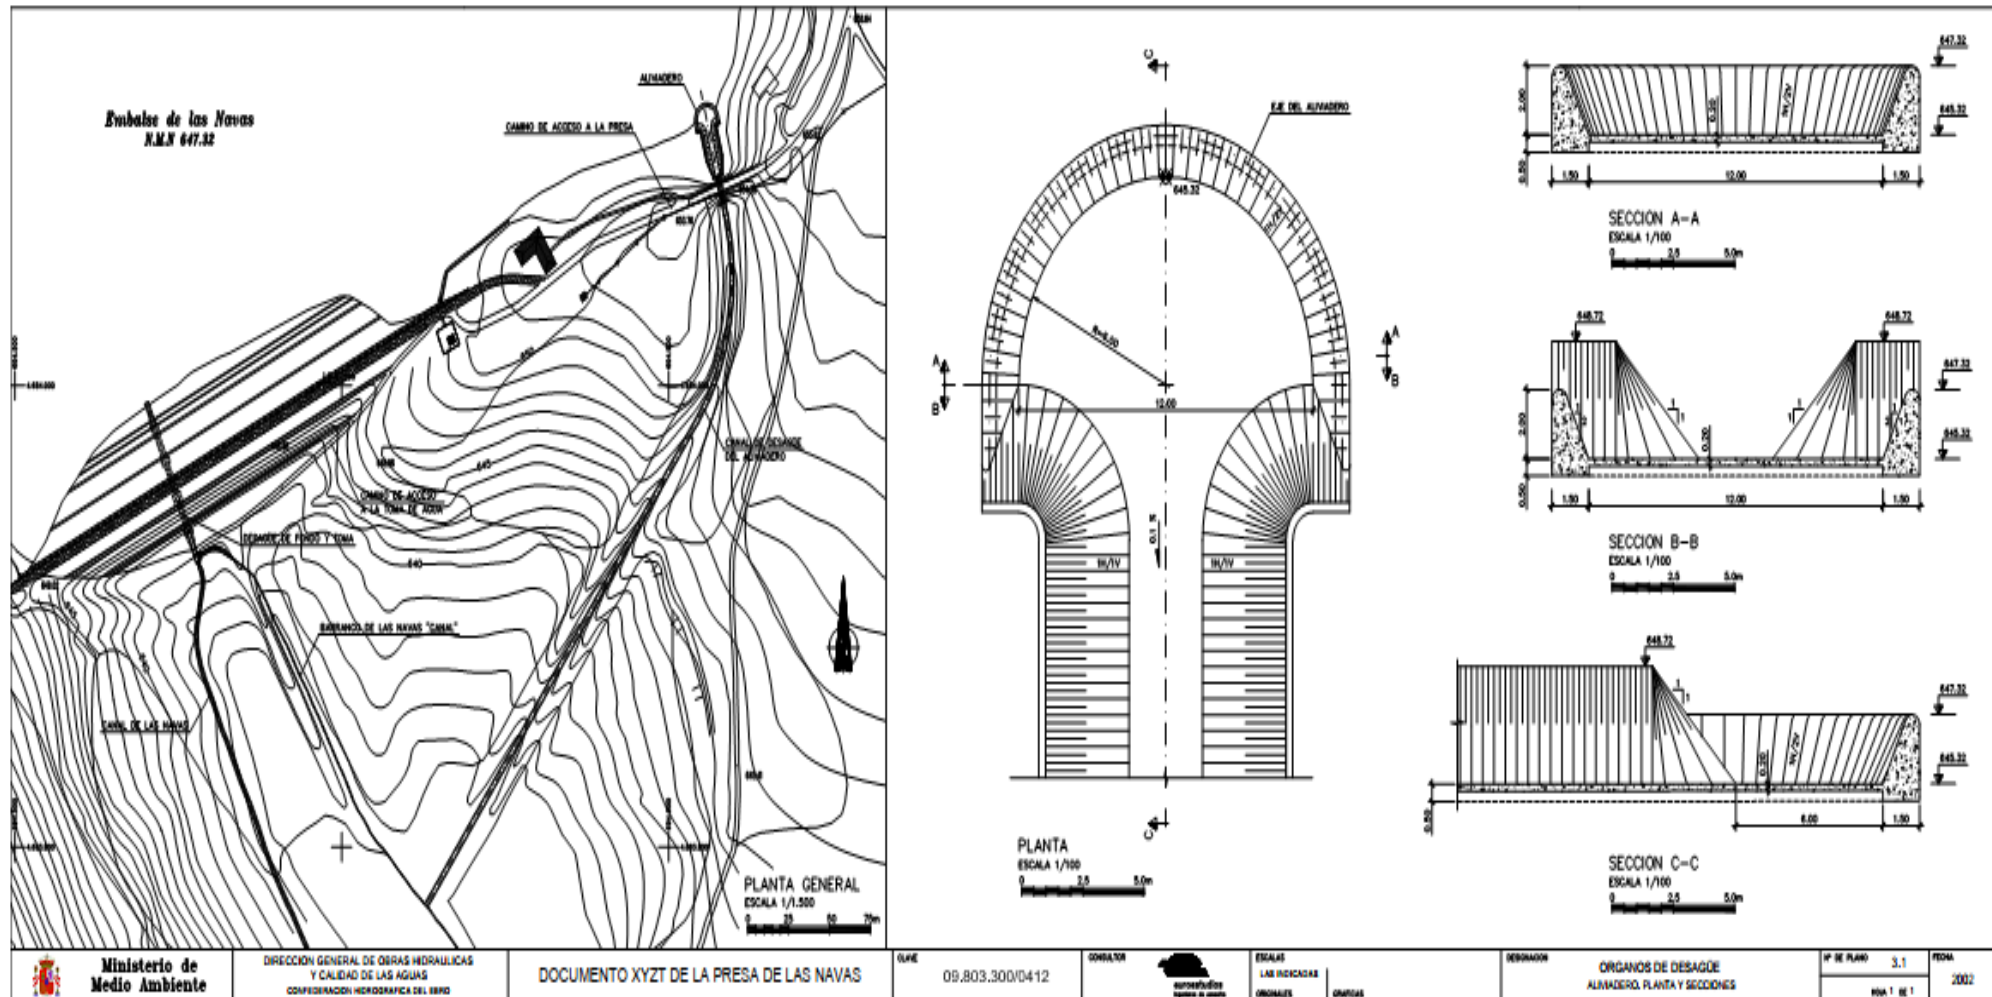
Plano 3.1. Aliviadero. Planta y secciones. Fuente: documento XYTZ de la presa de Las Navas (2003).
